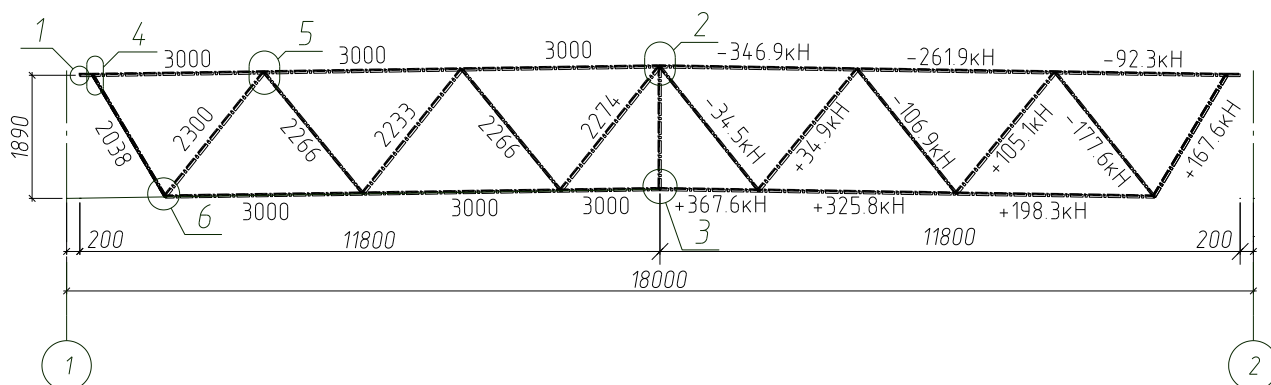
Схема расположения узлов к расчету и конструированию узлов фермы
